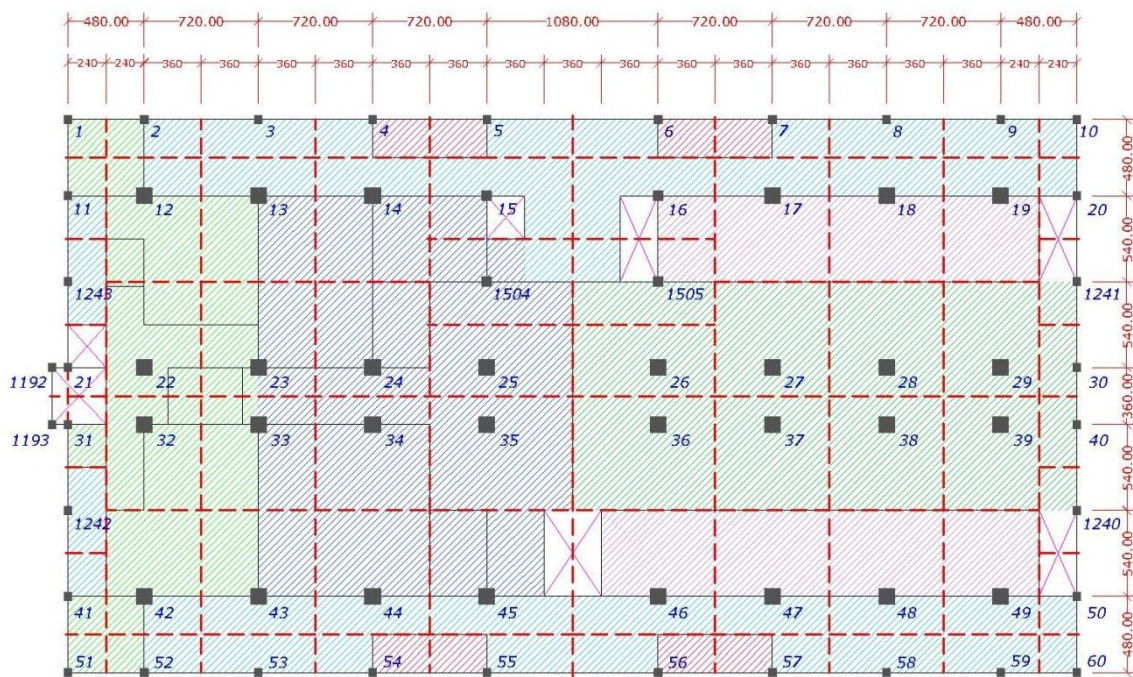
Tributary area kolom untuk beban balok pada lantai 8 hingga lantai 11
